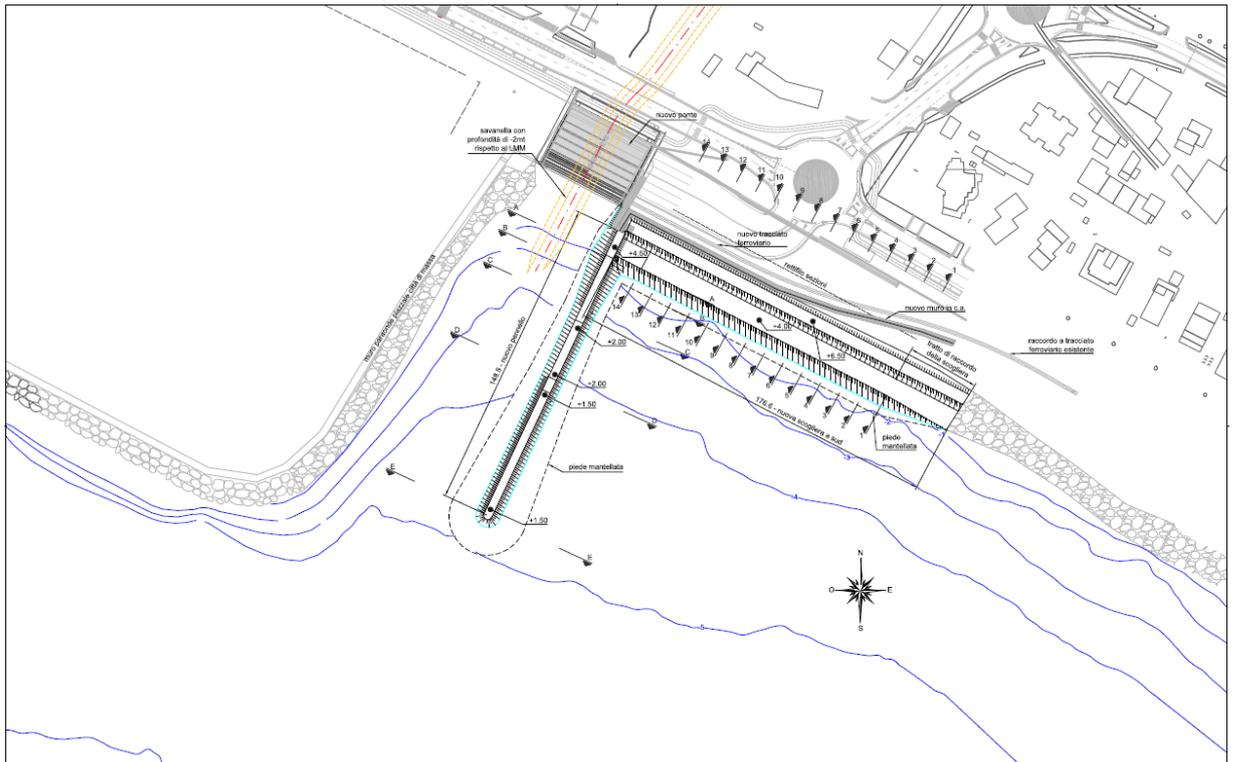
Planimetria opere previste nell'Ambito 1 (fonte: Elaborato OM.02.01 - AMBITO 1: “Opere Marittime – Stato di progetto”)
